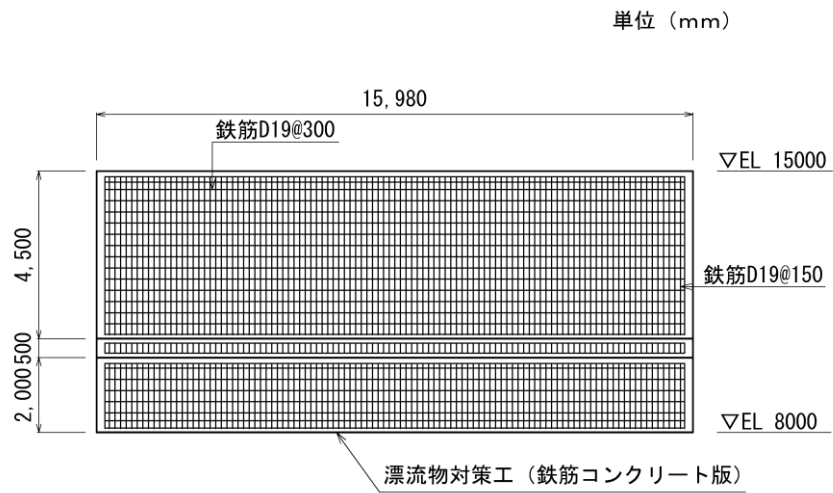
(1) 漂流物対策工 (鉄筋コンクリート版) の概略配筋図 (正面図)
